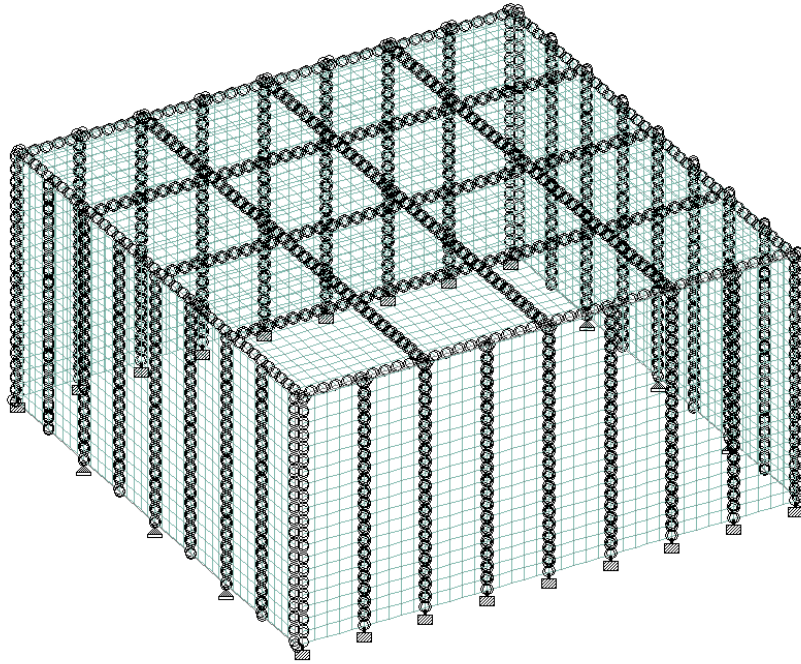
Modelo de cálculo completo con placas "Nave Modular TIPO 3"
